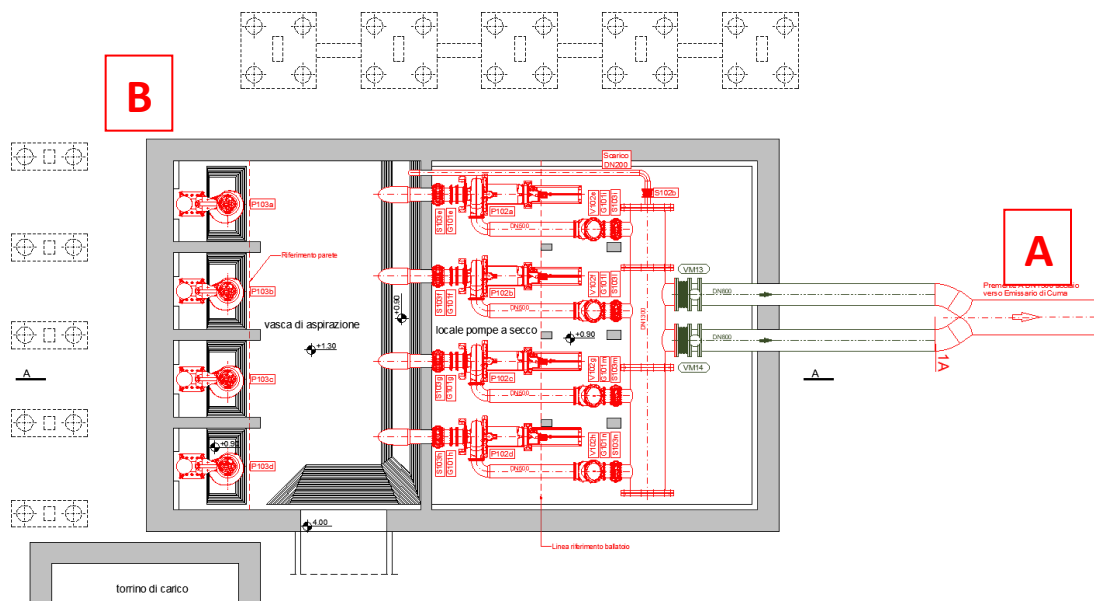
Sollevamenti all'emissario di Cuma – Pianta piano interrato - Stato di progetto
